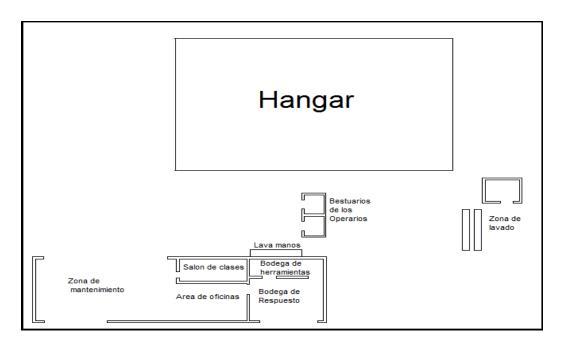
Distribución encontrada al inicio del plan de trabajo Fuente. Autor del proyecto
